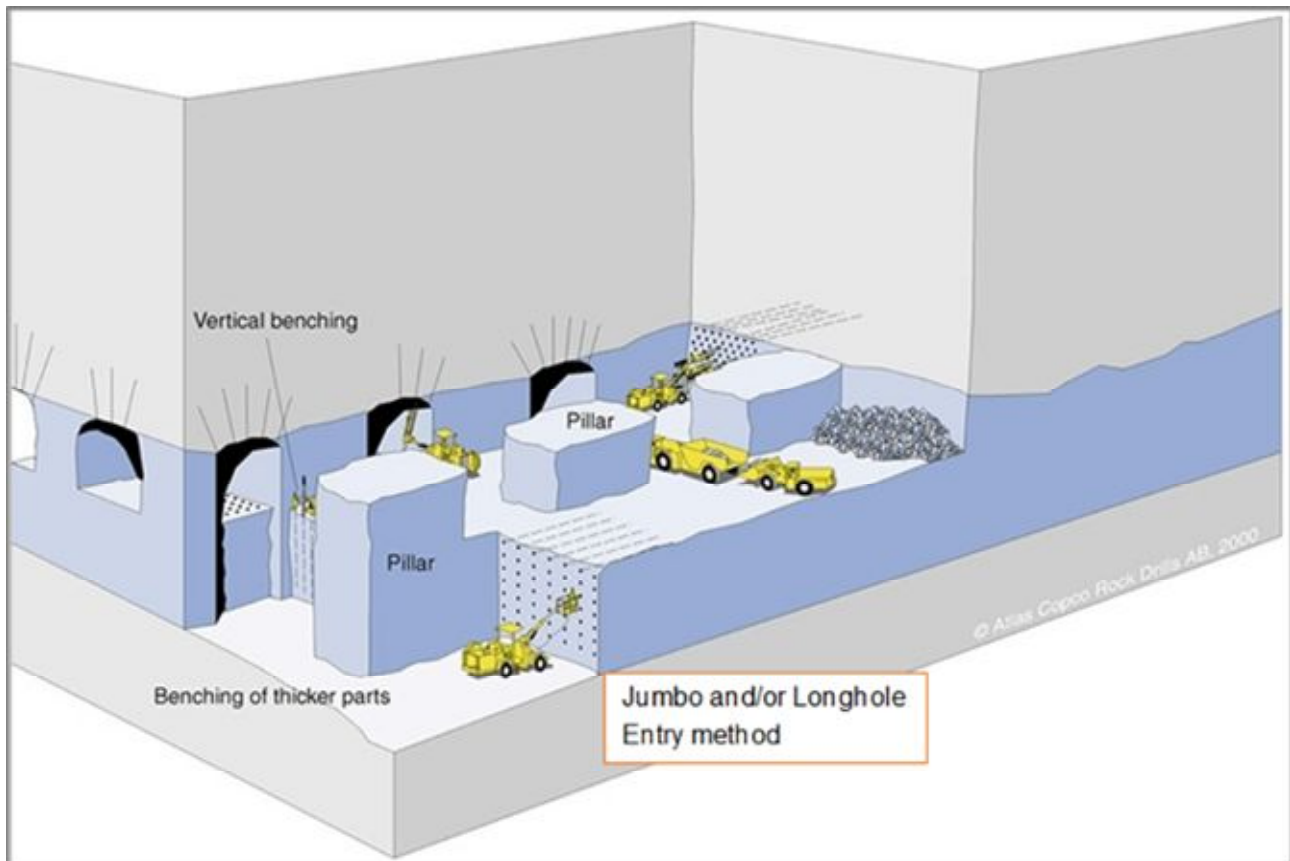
Schema del metodo di coltivazione "a camere e pilastri".
